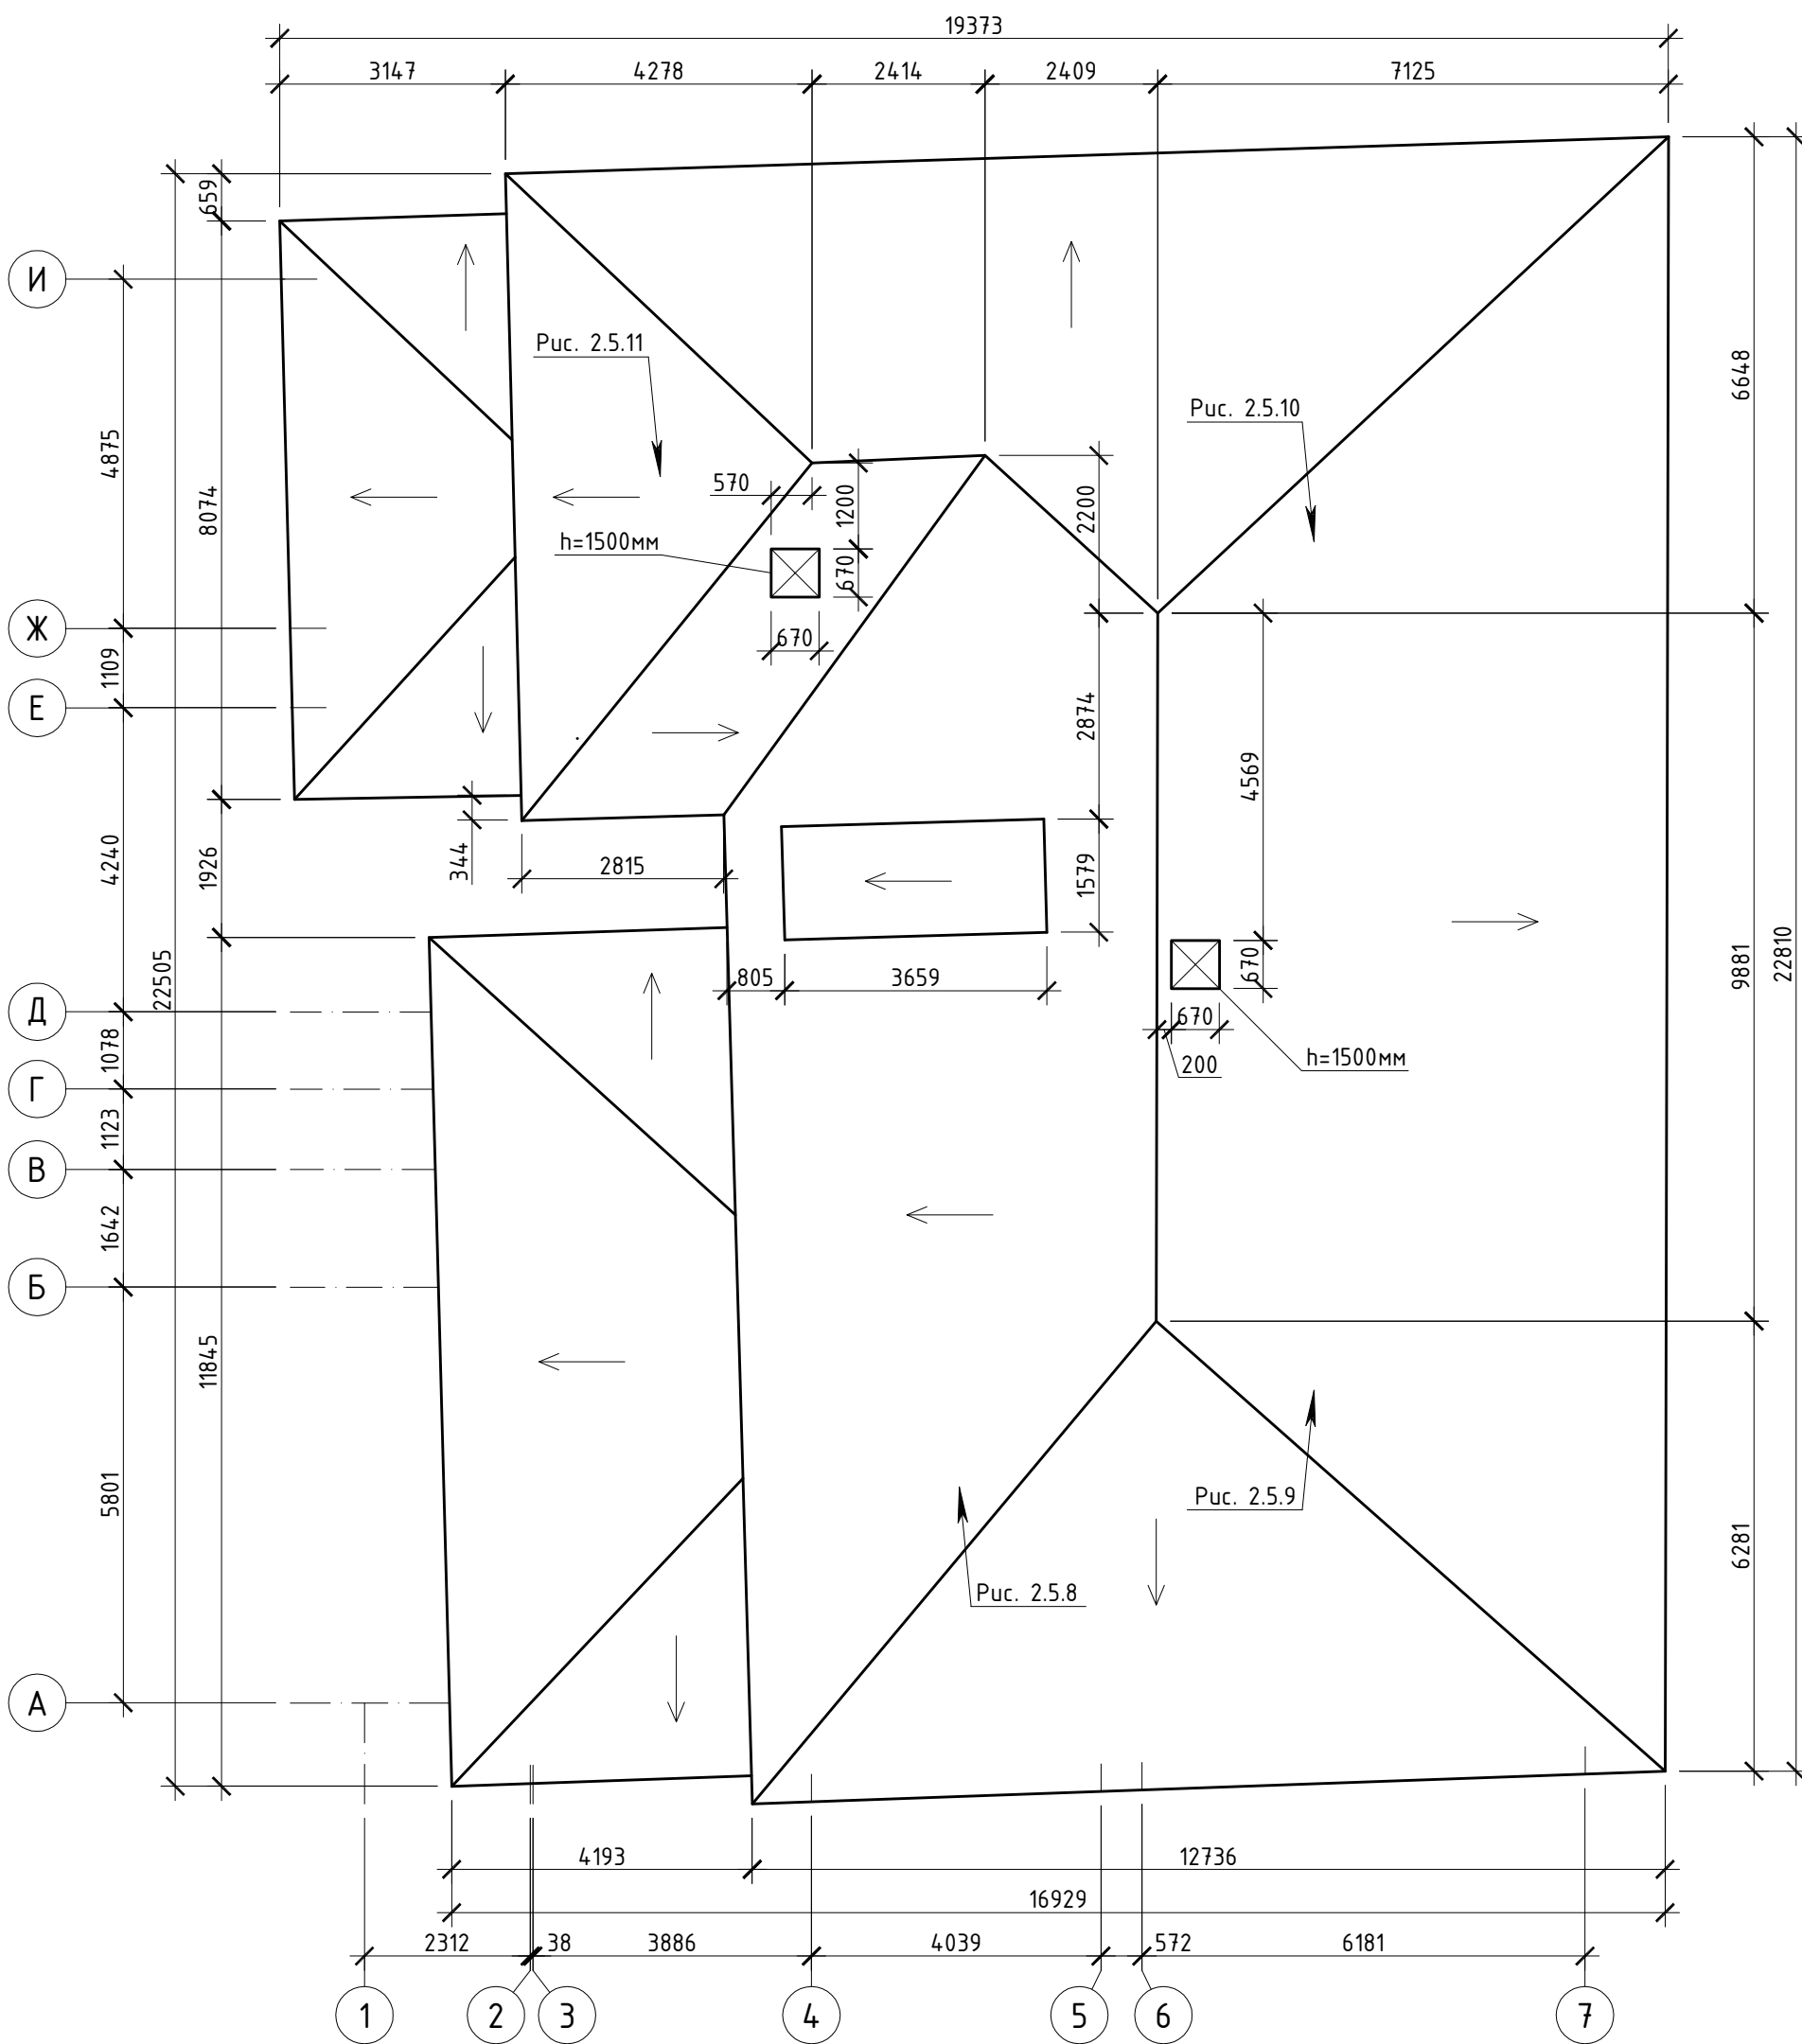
Схема кровли и схема фотофиксации
